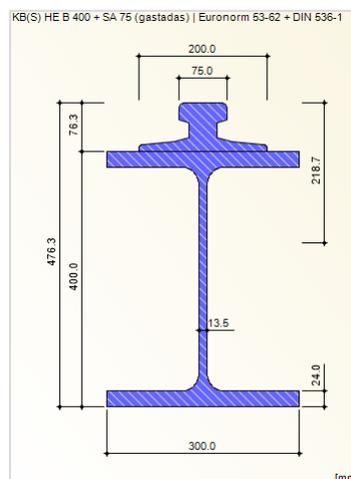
Sección de la viga carril: HEB 400+ carril SA-75
